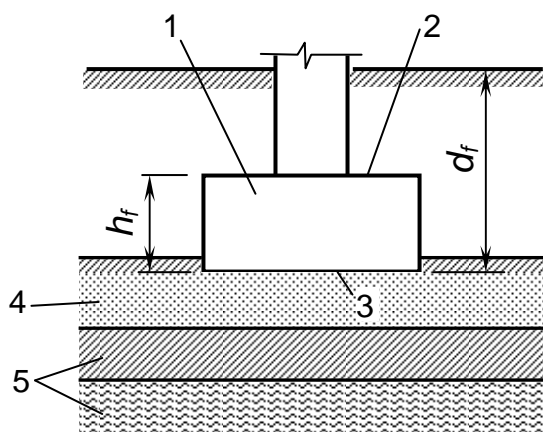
Схема фундамента и его основания: 1 – фундамент; 2 – обреза фундамента; 3 – подошва фундамента; 4 – несущий слой; 5 – подстилающие слои;  $h_f$  – высота фундамента;  $d_f$  – глубина заложения фундамента
